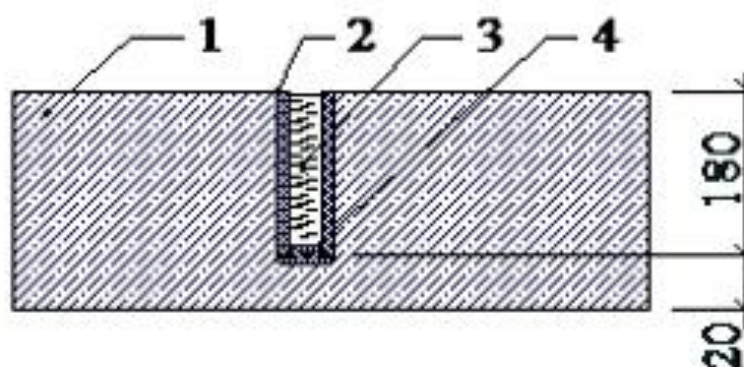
Устройство температурной скважины: 1-бетон плиты перекрытия; 2-трубка ПВХ; 3-теплопроводная жидкость; 4-заглушка.
